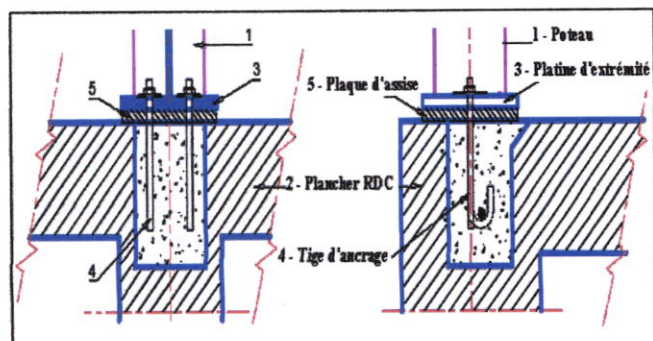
encrage poteau fondation ; source : auteurs 2018.
